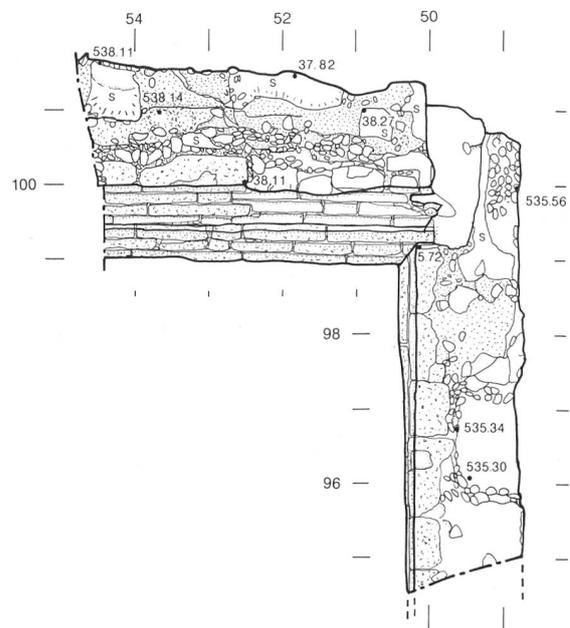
Bern, Schwanengasse 2. Grundriss und Ansichten des Stadtmauerfundes. Grau gerastert Ergänzung von 1989. M. 1:100.
